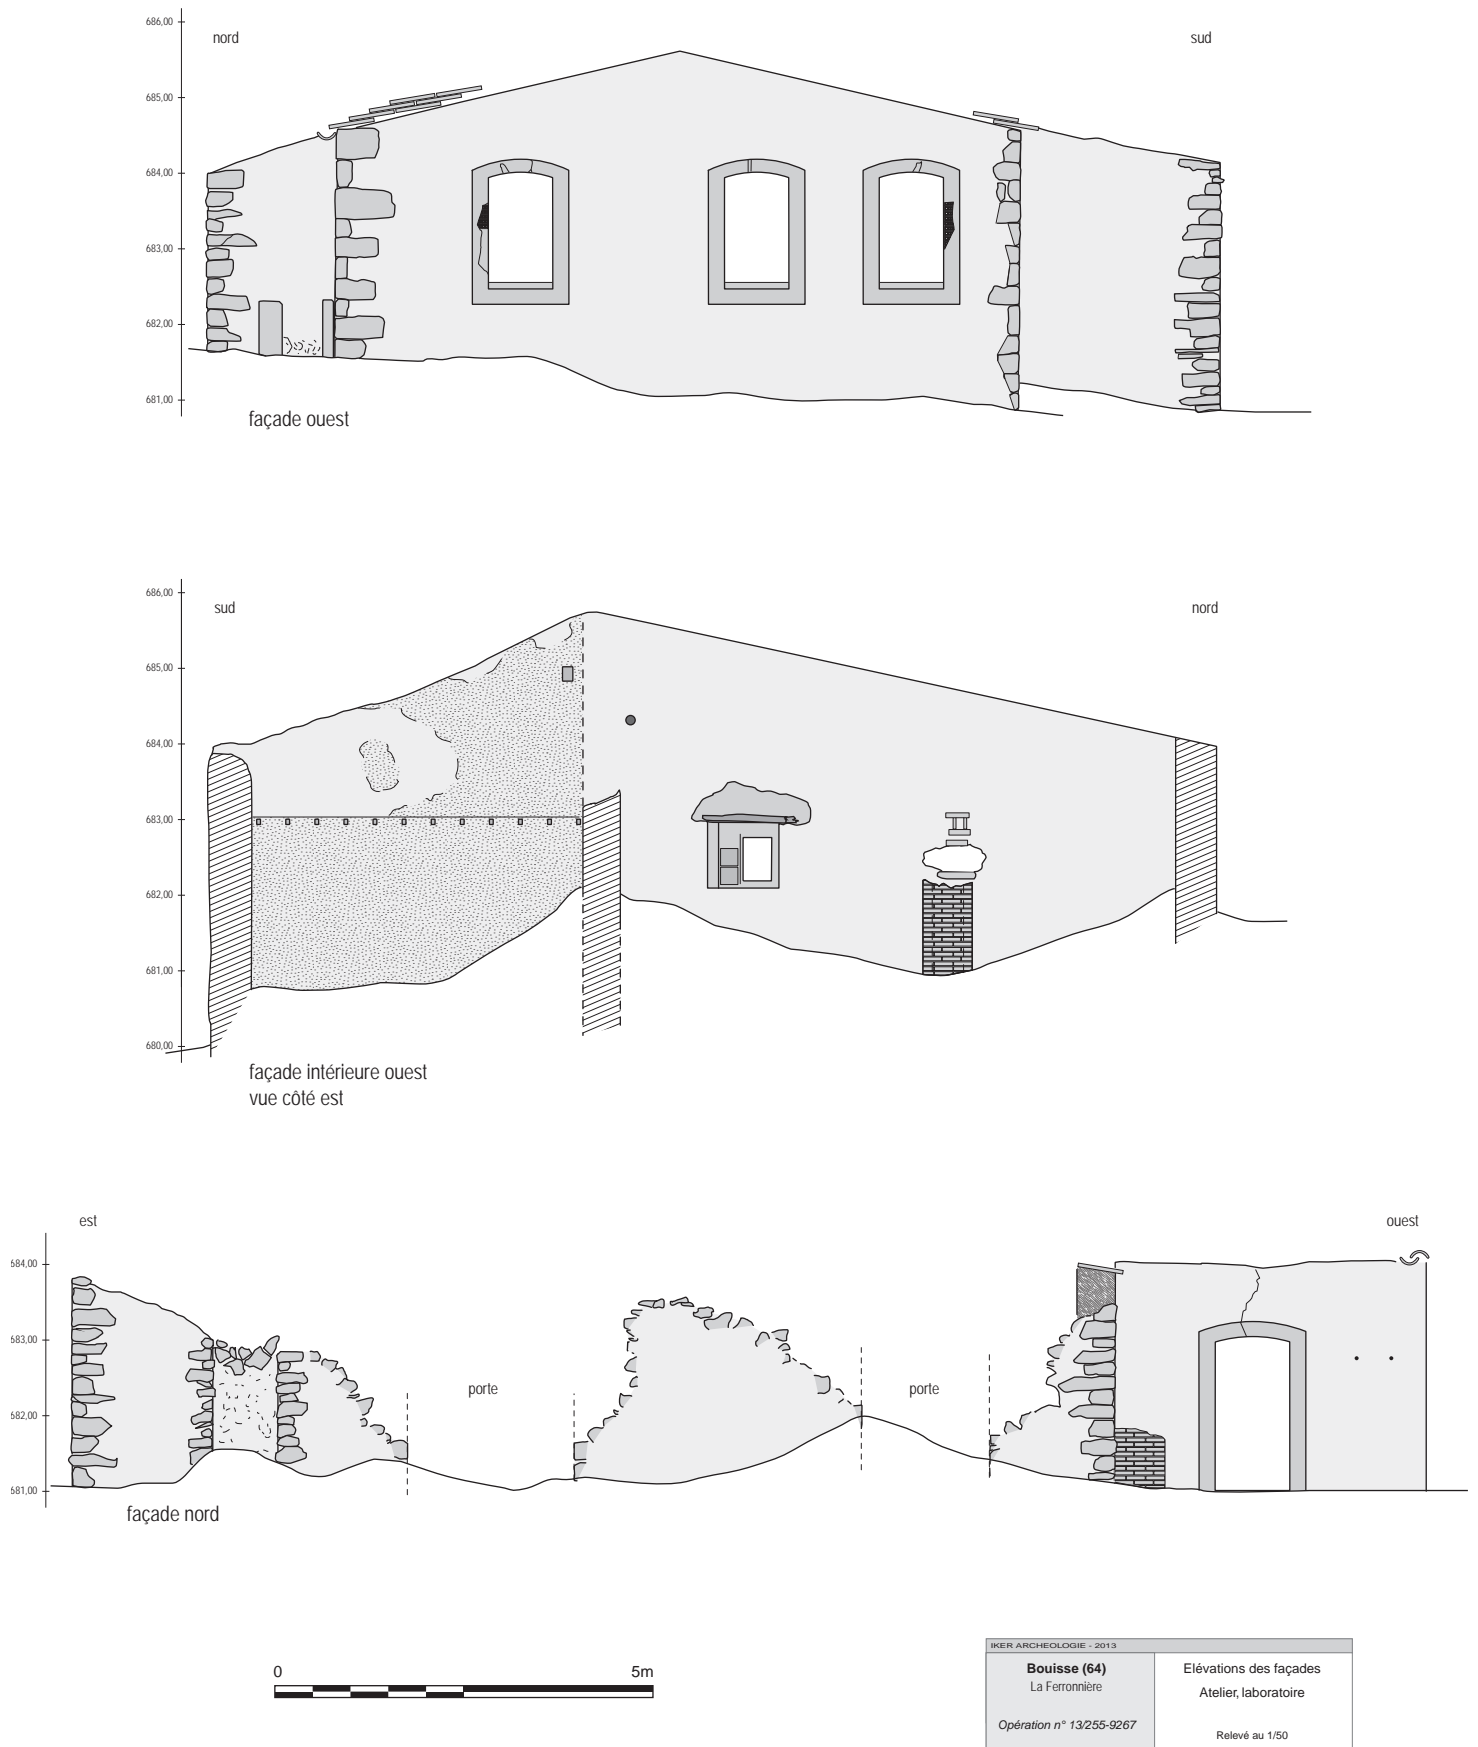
Elévations des façades de l'atelier et du laboratoire
